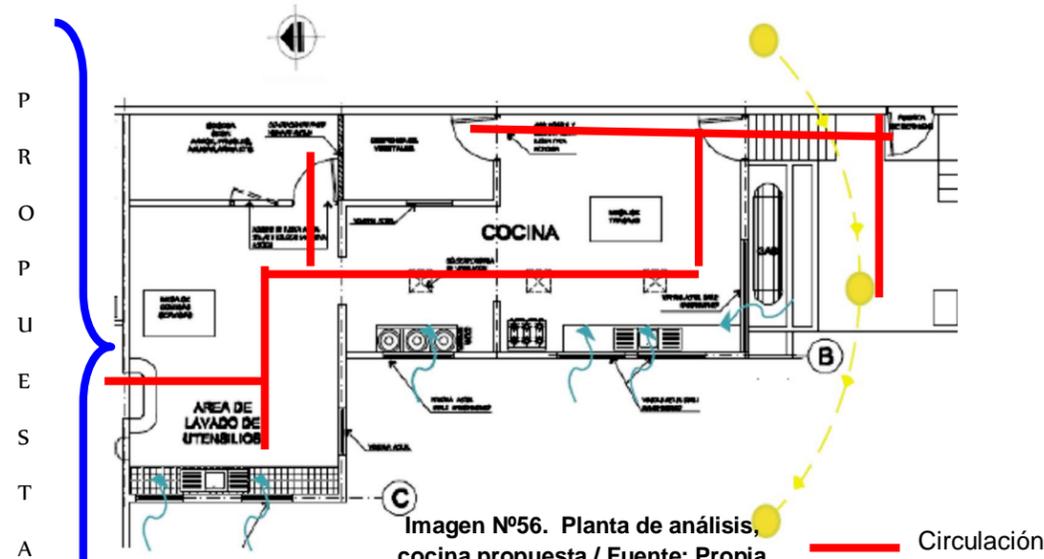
Planta de análisis, cocina propuesta./ Fuente: Propia
